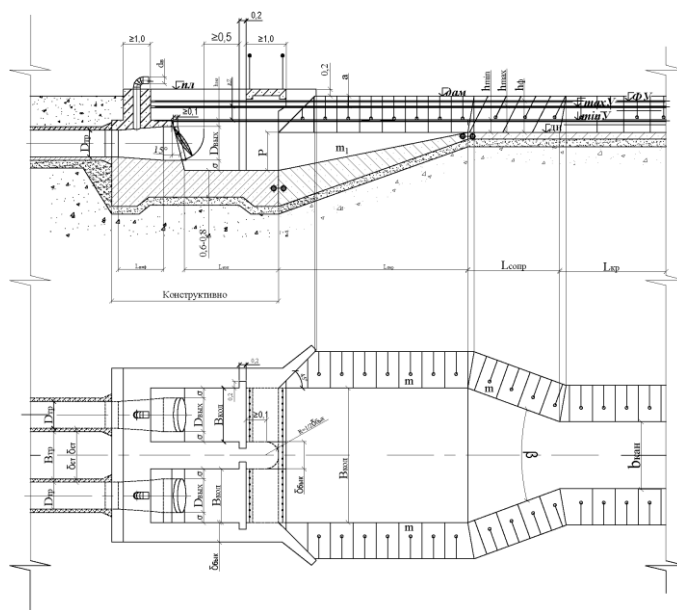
Водовыпускное сооружение, оборудованное клапанами – захлопками
